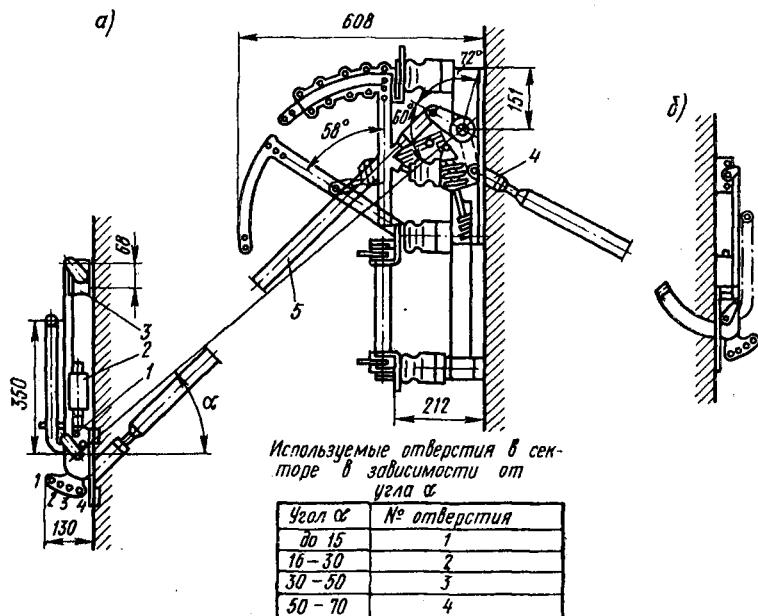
Установка выключателя нагрузки с приводом ПРА-17:
